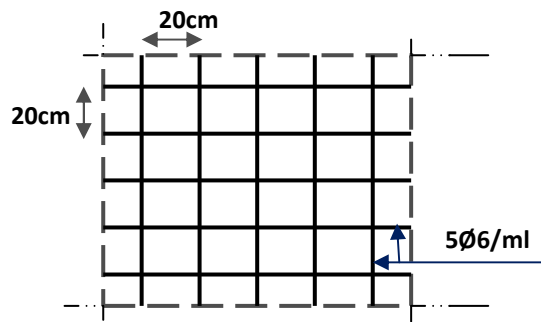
Schéma de ferrailage de la dalle de compression.
